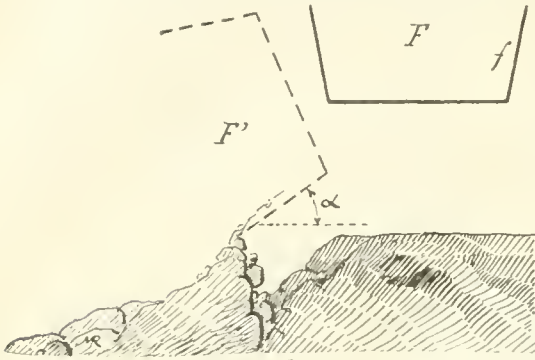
Coupe transversale du coffre d'une brouette du type français.
